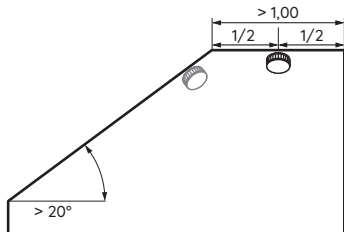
Surface de montage droite d'une longueur et d'une largeur d'au moins 1 m
